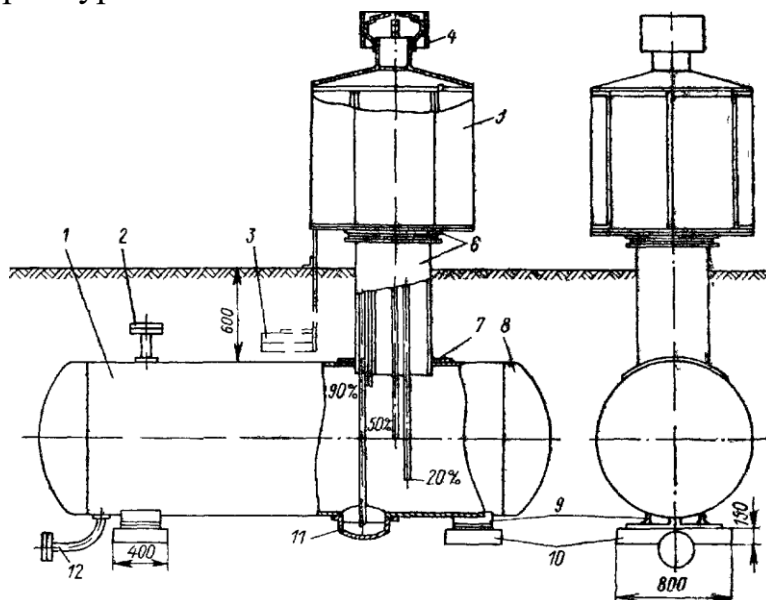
Подземный резервуар для хранения сжиженного газа: 1 - цилиндрическая часть; 2 - патрубок паровой фазы; 3 - опорные плиты для крепления защитного кожуха; 4 - дефлектор; 5 - защитный кожух; 6 - горловина; 7 - воротник для усиления сварного шва; 8 - сферическое днище; 9 - опоры; 10 - фундамент; 11 - отстойник; 12 - патрубок жидкой фазы
